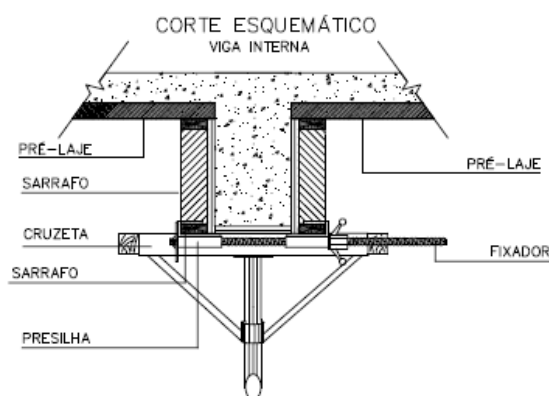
corte esquemático do apoio da pré-laje no painel interno das vigas internas⁵
